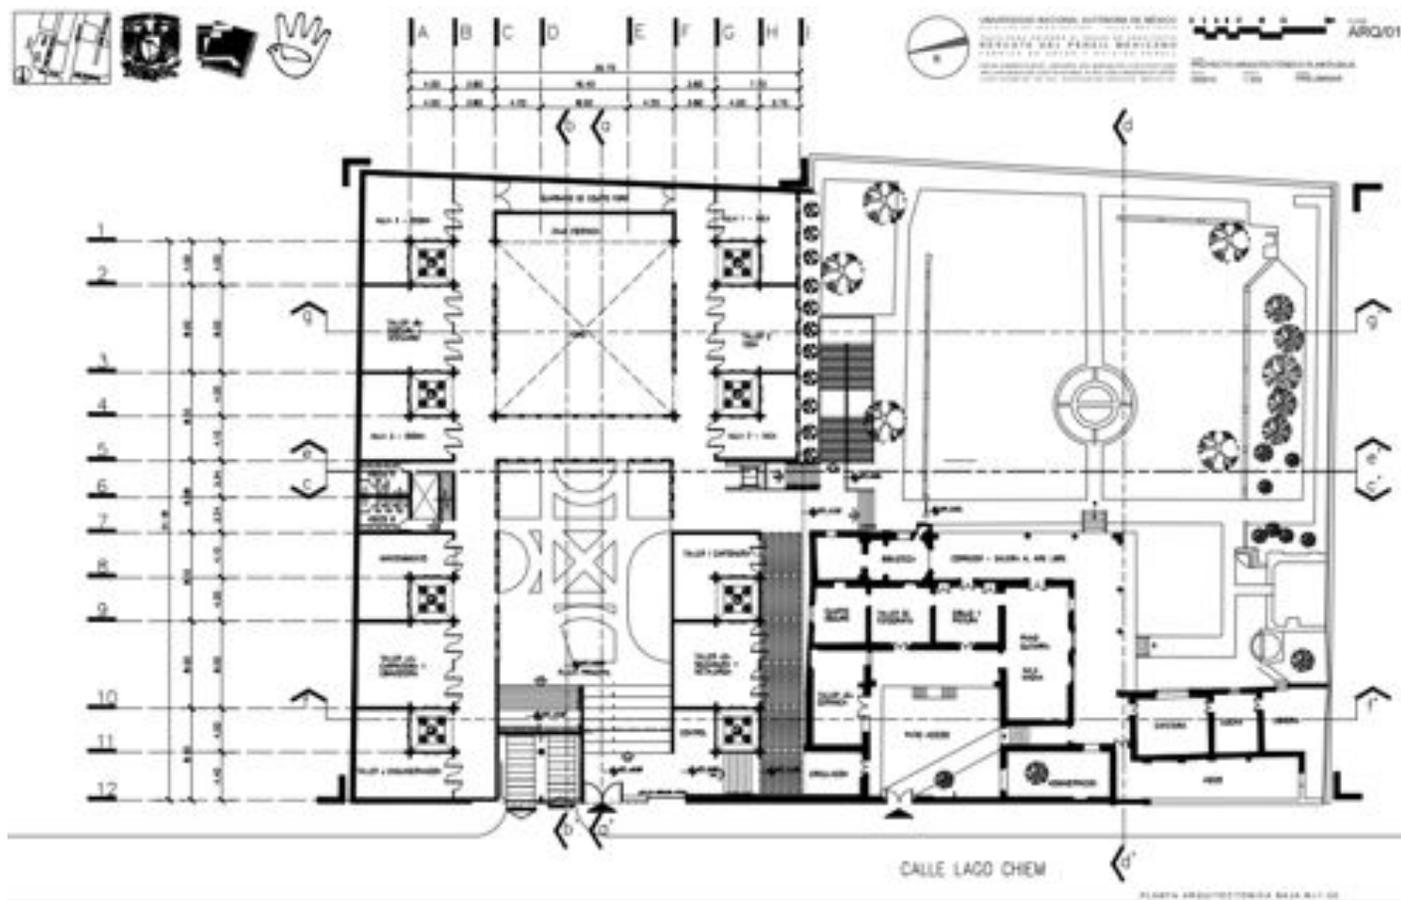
Planta arquitectónica baja. El acceso está solucionado de tal suerte que dirige a la plaza principal, apta para eventos al aire libre gracias a la escalinata situada al norte. Los dos espacios principales (plaza principal y foro, al oriente) articulan alrededor de sí los módulos de 12x12m que, a su vez, tienen patios centrales y que contienen las aulas y talleres. Es importante notar cómo se procura mantener una escala general y dar una escala particular a las aulas gracias a los citados jardines de 4x4m, en tanto el conjunto mantiene una escala mucho más grande consigo mismo. Al centro y norte del edificio se localiza un núcleo de servicios, en tanto en el centro y sur se encuentra la salida del estacionamiento y la comunicación entre la antigua casa y la parte nueva.
